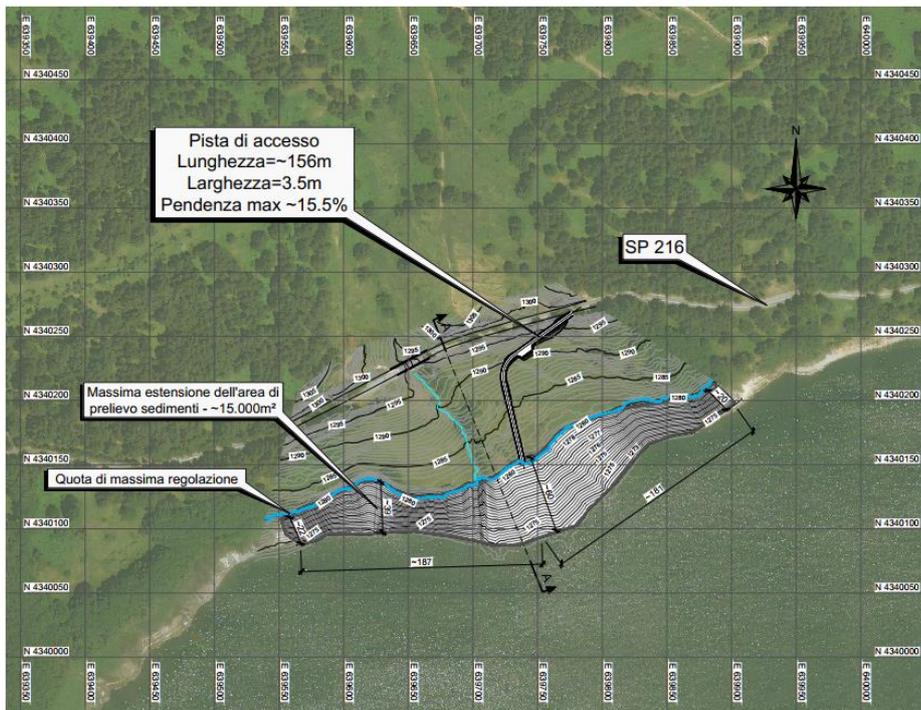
sito di prelievo Tout-Venant (CV), sito 3, planimetria
